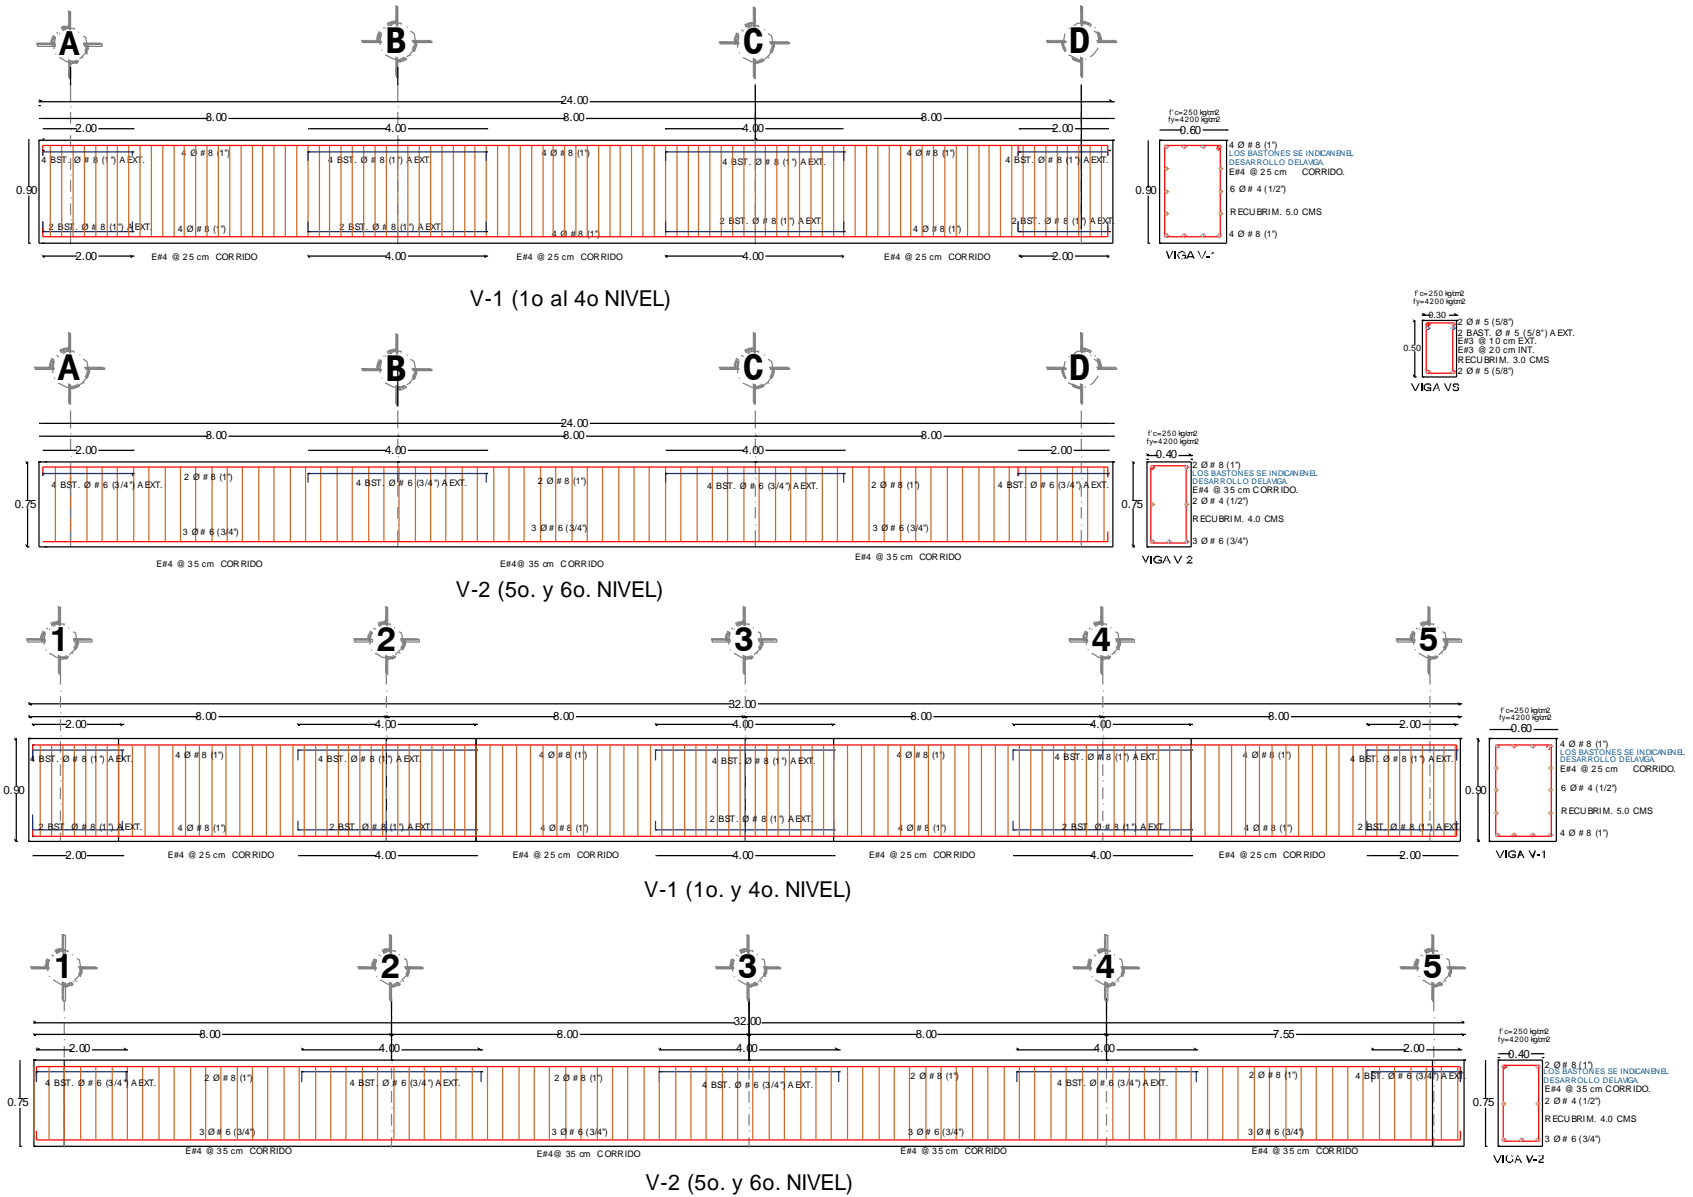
Detallado de armado de vigas de edificio de 6 niveles con base a la hipótesis de las NTCC-17.
